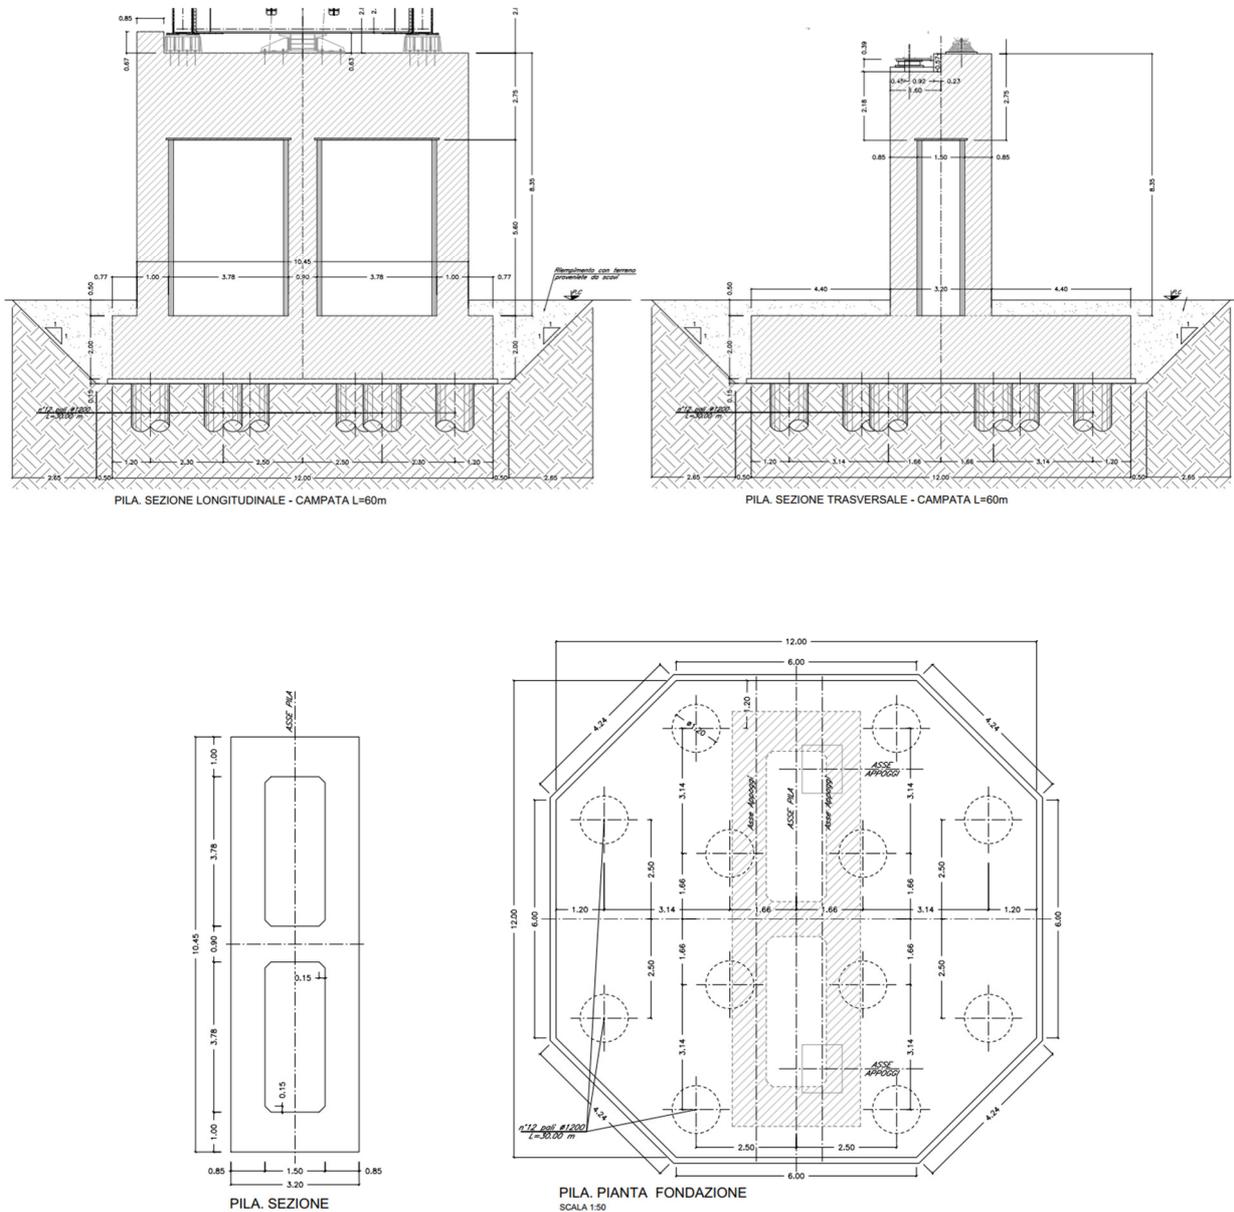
Geometria pile VI01 campata da 60 m. Dimensioni in m
